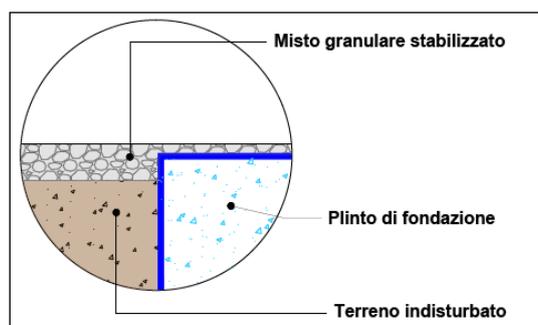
Particolare pavimentazione piazzola tipo in fase di esecuzione lavori
